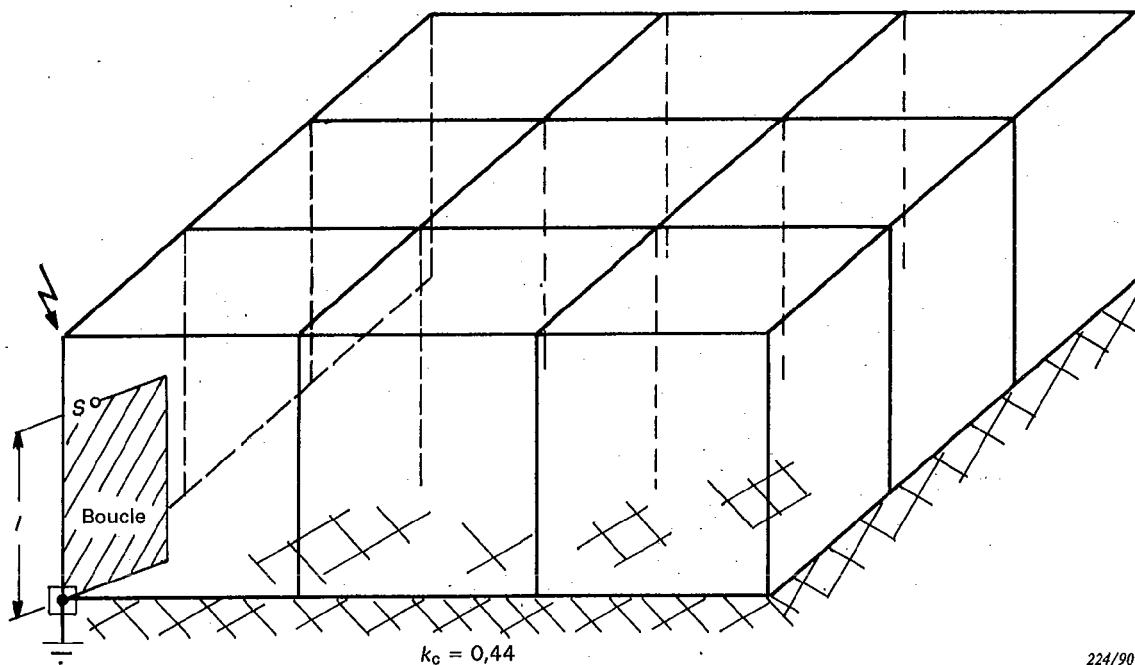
Proximité de l'installation de protection contre la foudre et d'autres installations.
